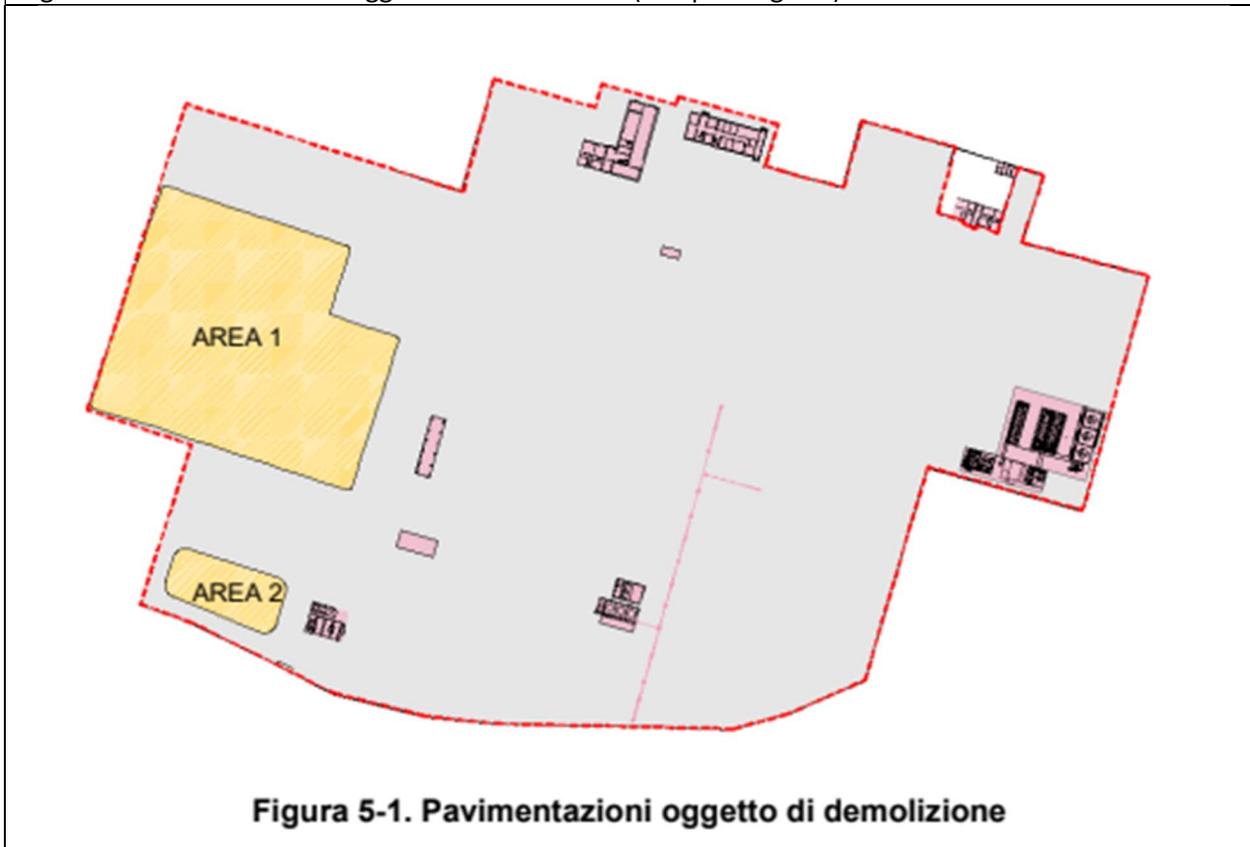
B – Pavimentazioni oggetto di demolizione (campitura gialla)
